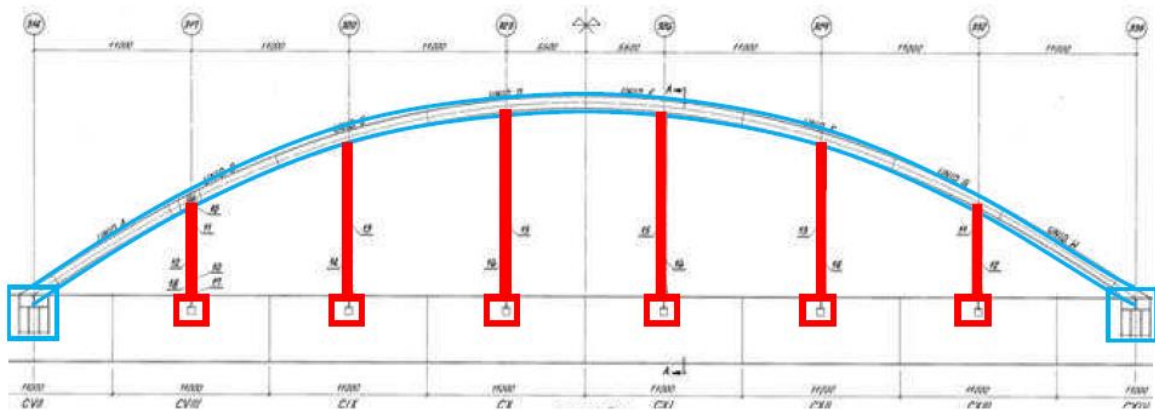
Elevação do arco metálico e tirantes ligados ao caixão metálico (em destaque)
